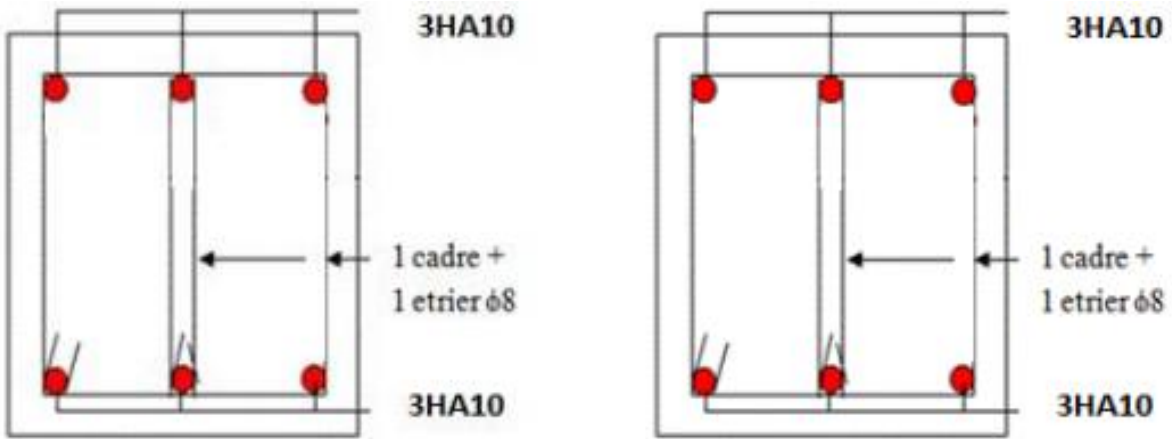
Schémas de ferrailage des poutres de chaînage.
